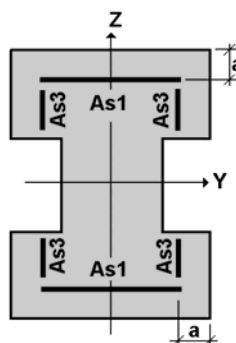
Размещение «площадей» продольной арматуры
